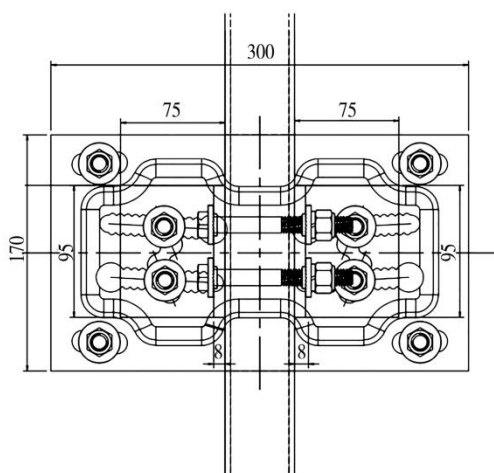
免焊装配式板槽埋板正立面图
